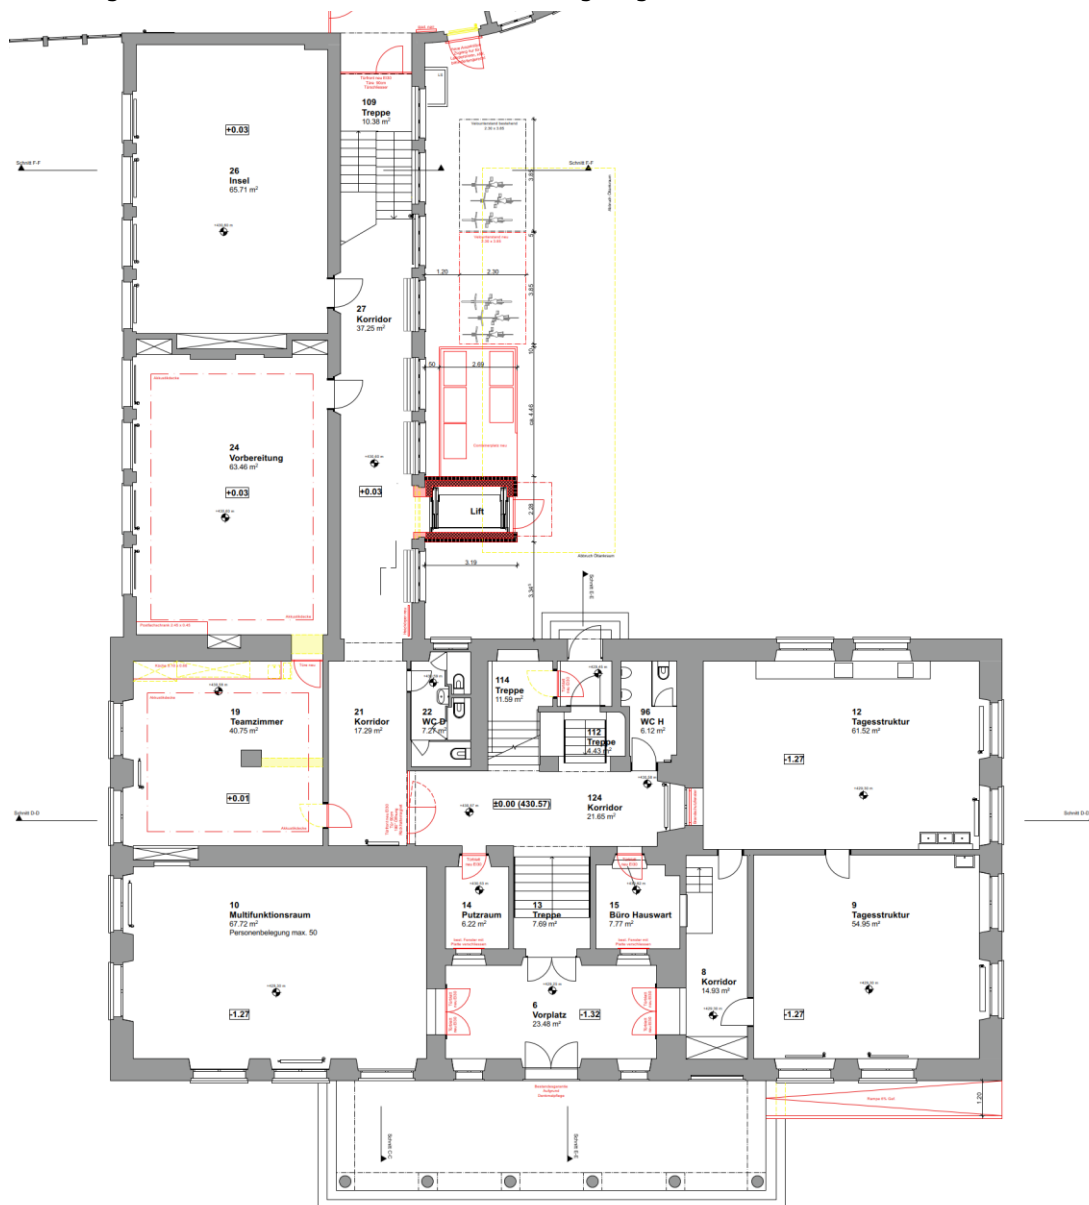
Grundrissplan Erdgeschoss Teil Haupt- und Zwischentrakt
